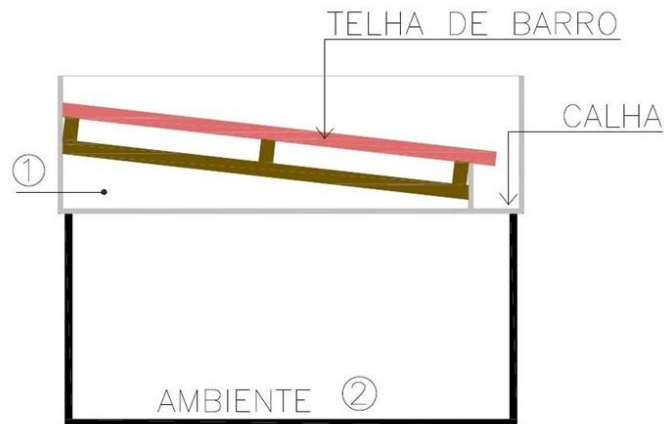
Corte esquemático - telhado convencional. Fonte: Adaptado de Souza 2016.
